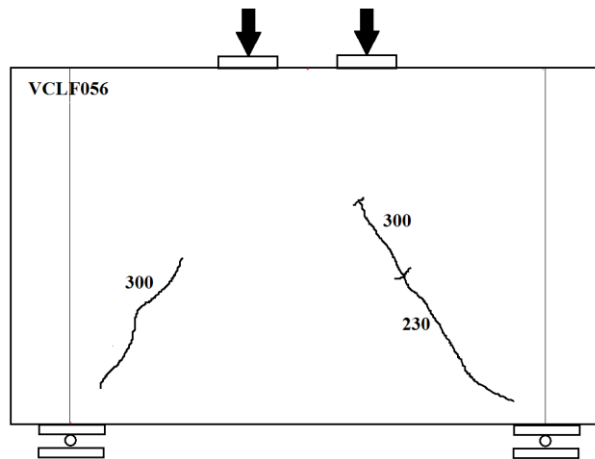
Esquema de fissuração da viga VCLF056.
